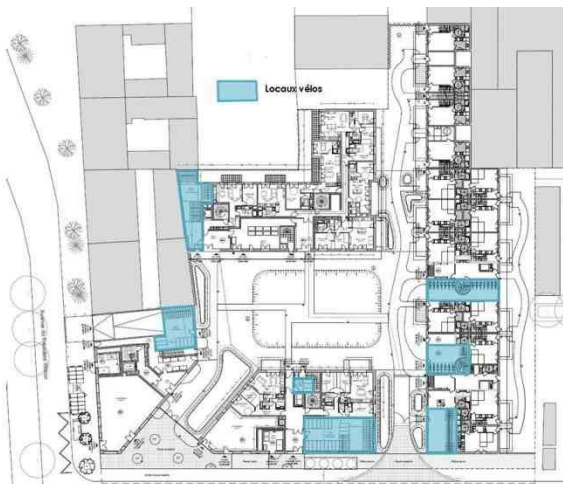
Locaux vélos au rez-de-chaussées (p. 36)
